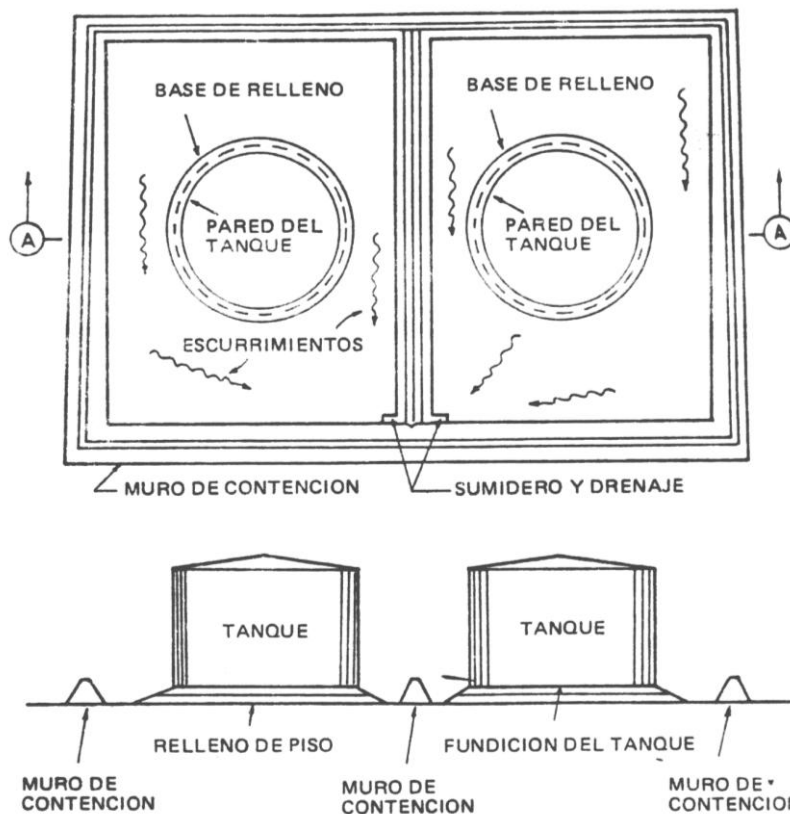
Áreas de tanques con muros de contención - Detalles
